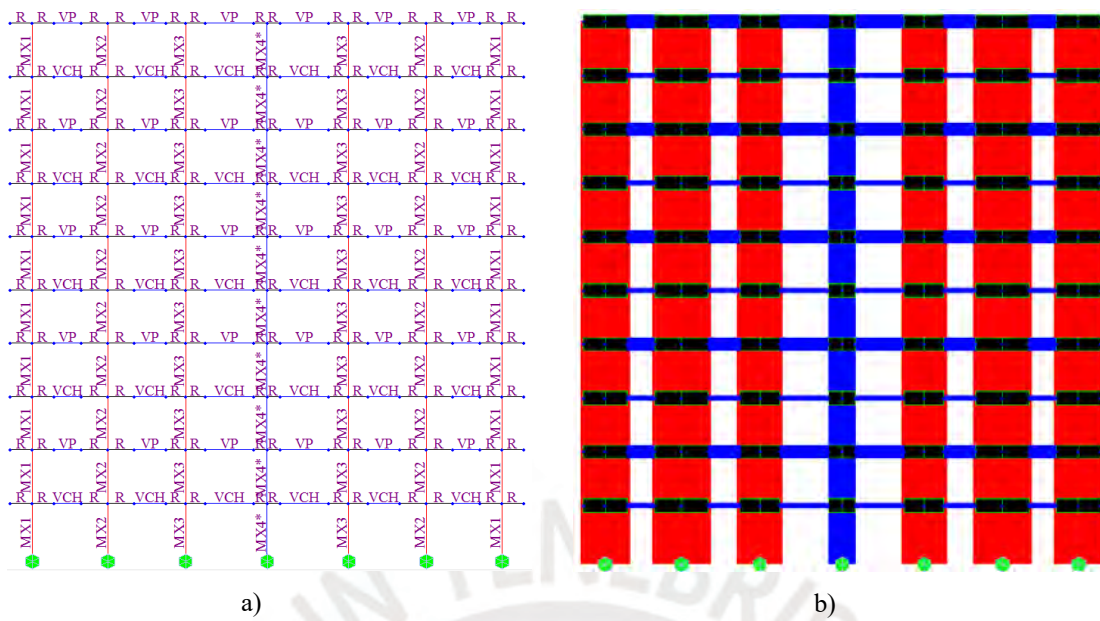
Modelamiento en MidasGen-eje A, a) Vista alámbrica, b) Vista renderizada.
